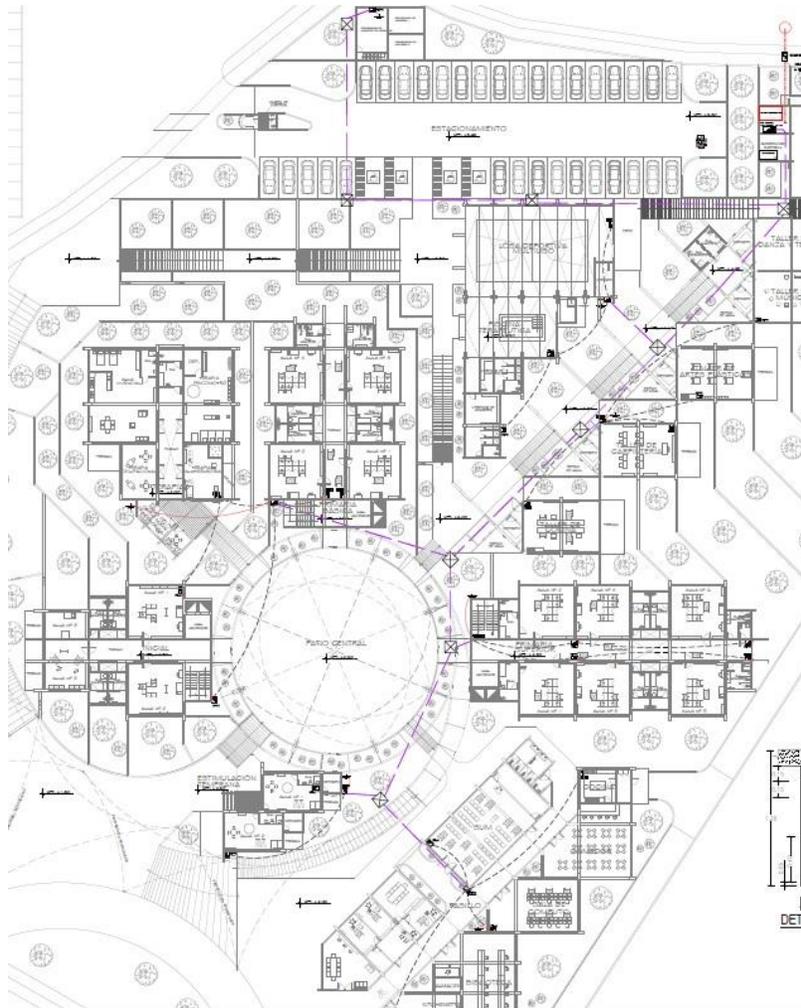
Plano de distribución eléctrica de primer piso. Fuente Elaboración propia.
